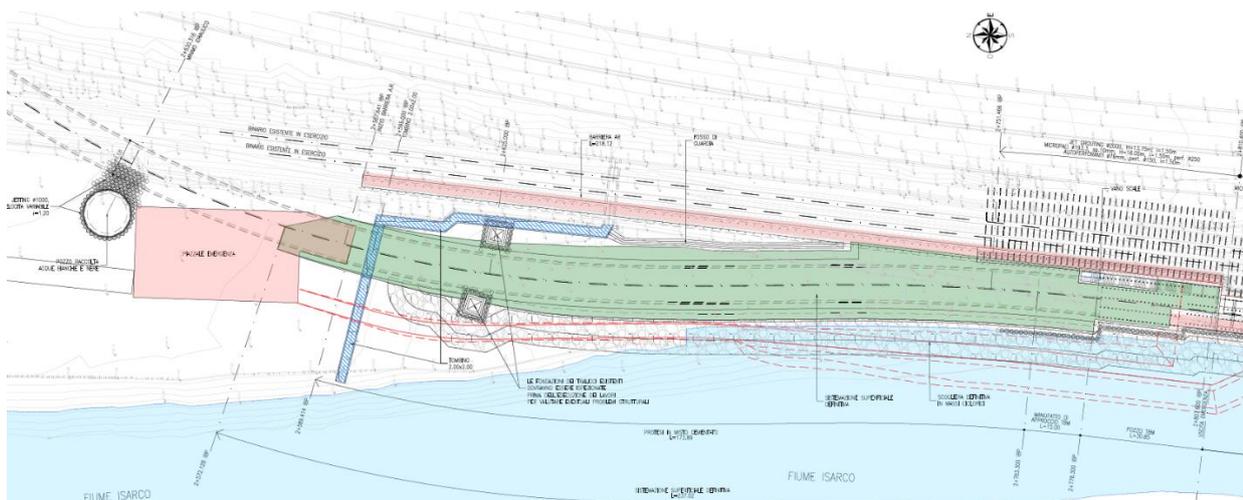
Planimetria dell'imbocco (Parte 1/2)
